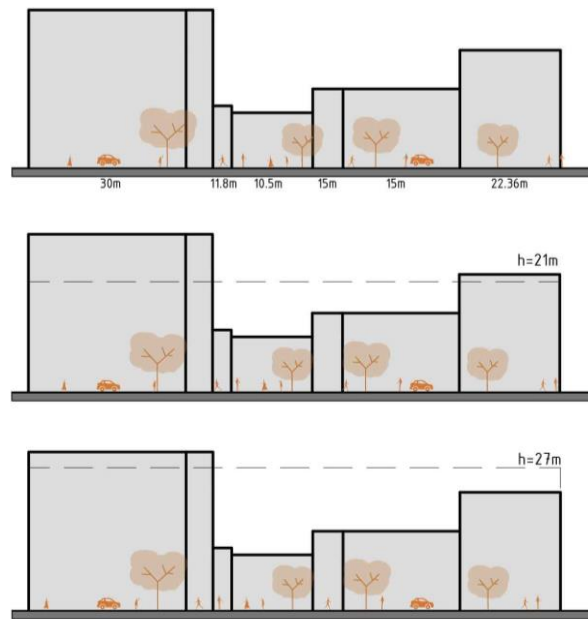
Vistas 2 do terreno analisado para as fachadas da Rua Conselheiro Josino.
